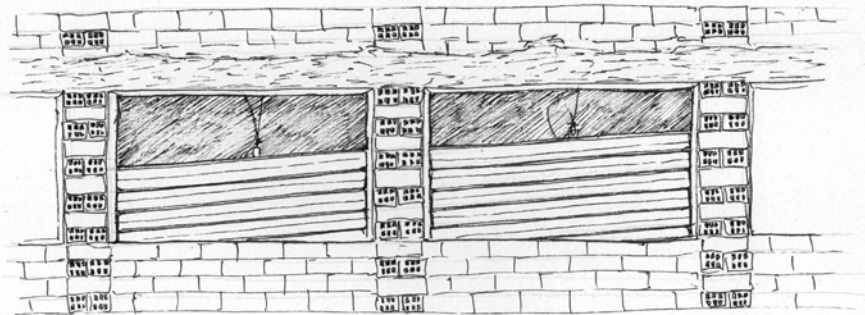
Detalle de huecos de ventana en cerramiento secadero de cerramiento cerámico. Las huecos se forman entre las pilastras y de ayudan de dinteles prefabricados de hormigón armado.
